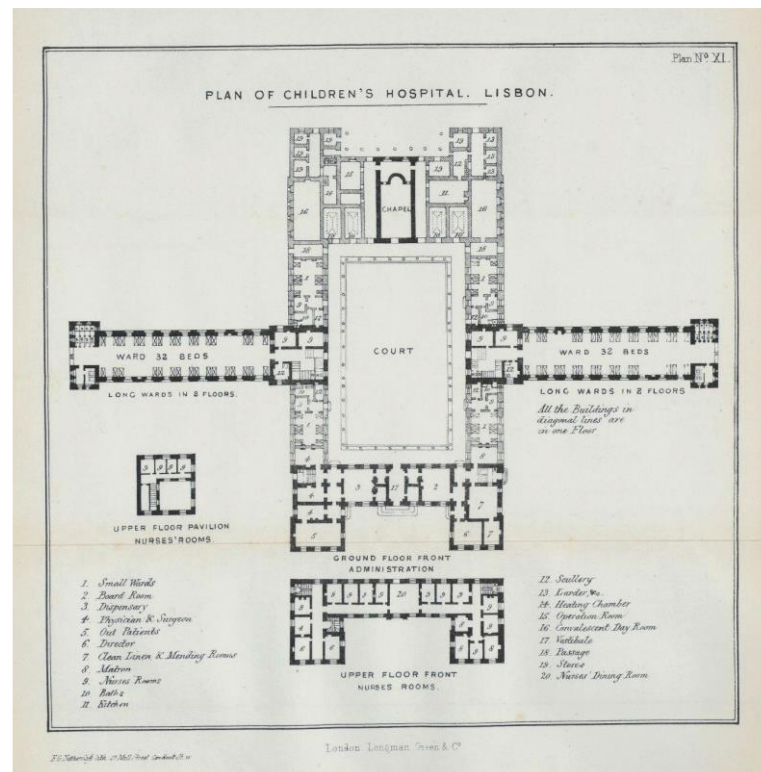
Planta do Hospital Dona Estefânia. Fonte: Pinto, 2014.
